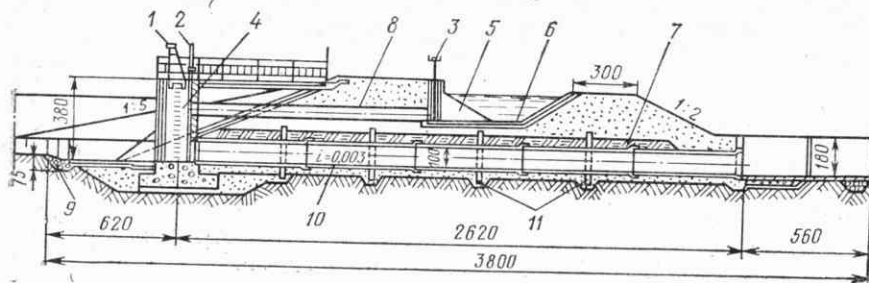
Донный водоспуск-водовыпуск конструкции Гидрорыбпроекта для выростных и нагульных прудов при «веерной» схеме их расположения:
